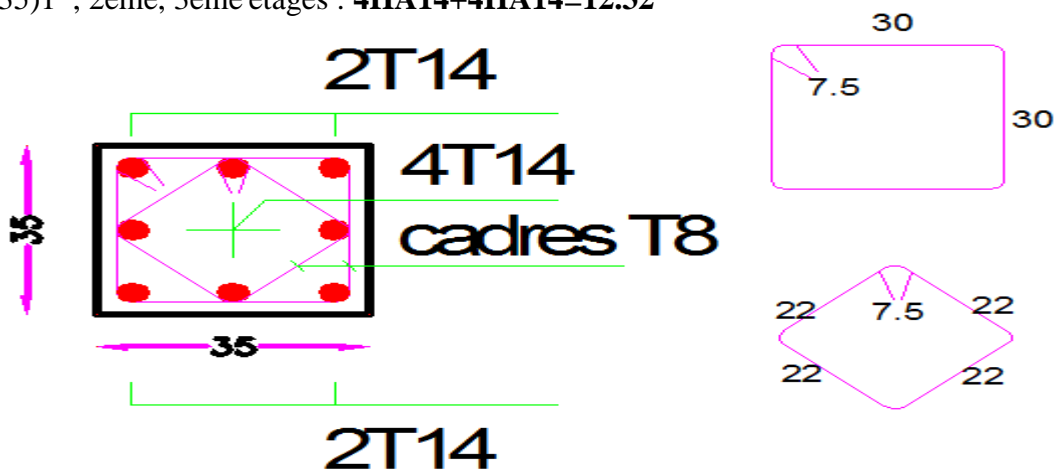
Schéma de ferrailage du poteau^{1^{er}}, 2^{eme}, 3^{eme} étages.
